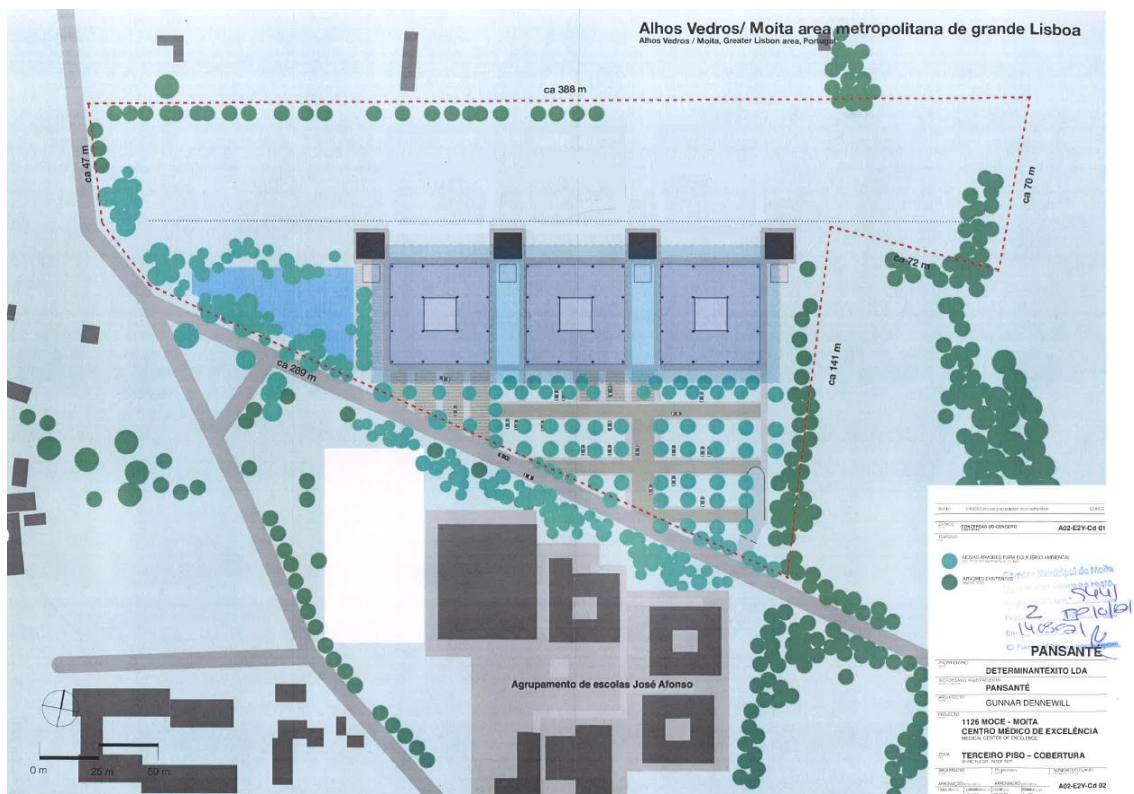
| Apresentação de PIP: Planta MOCE – Moita Centro Médico de Excelência
